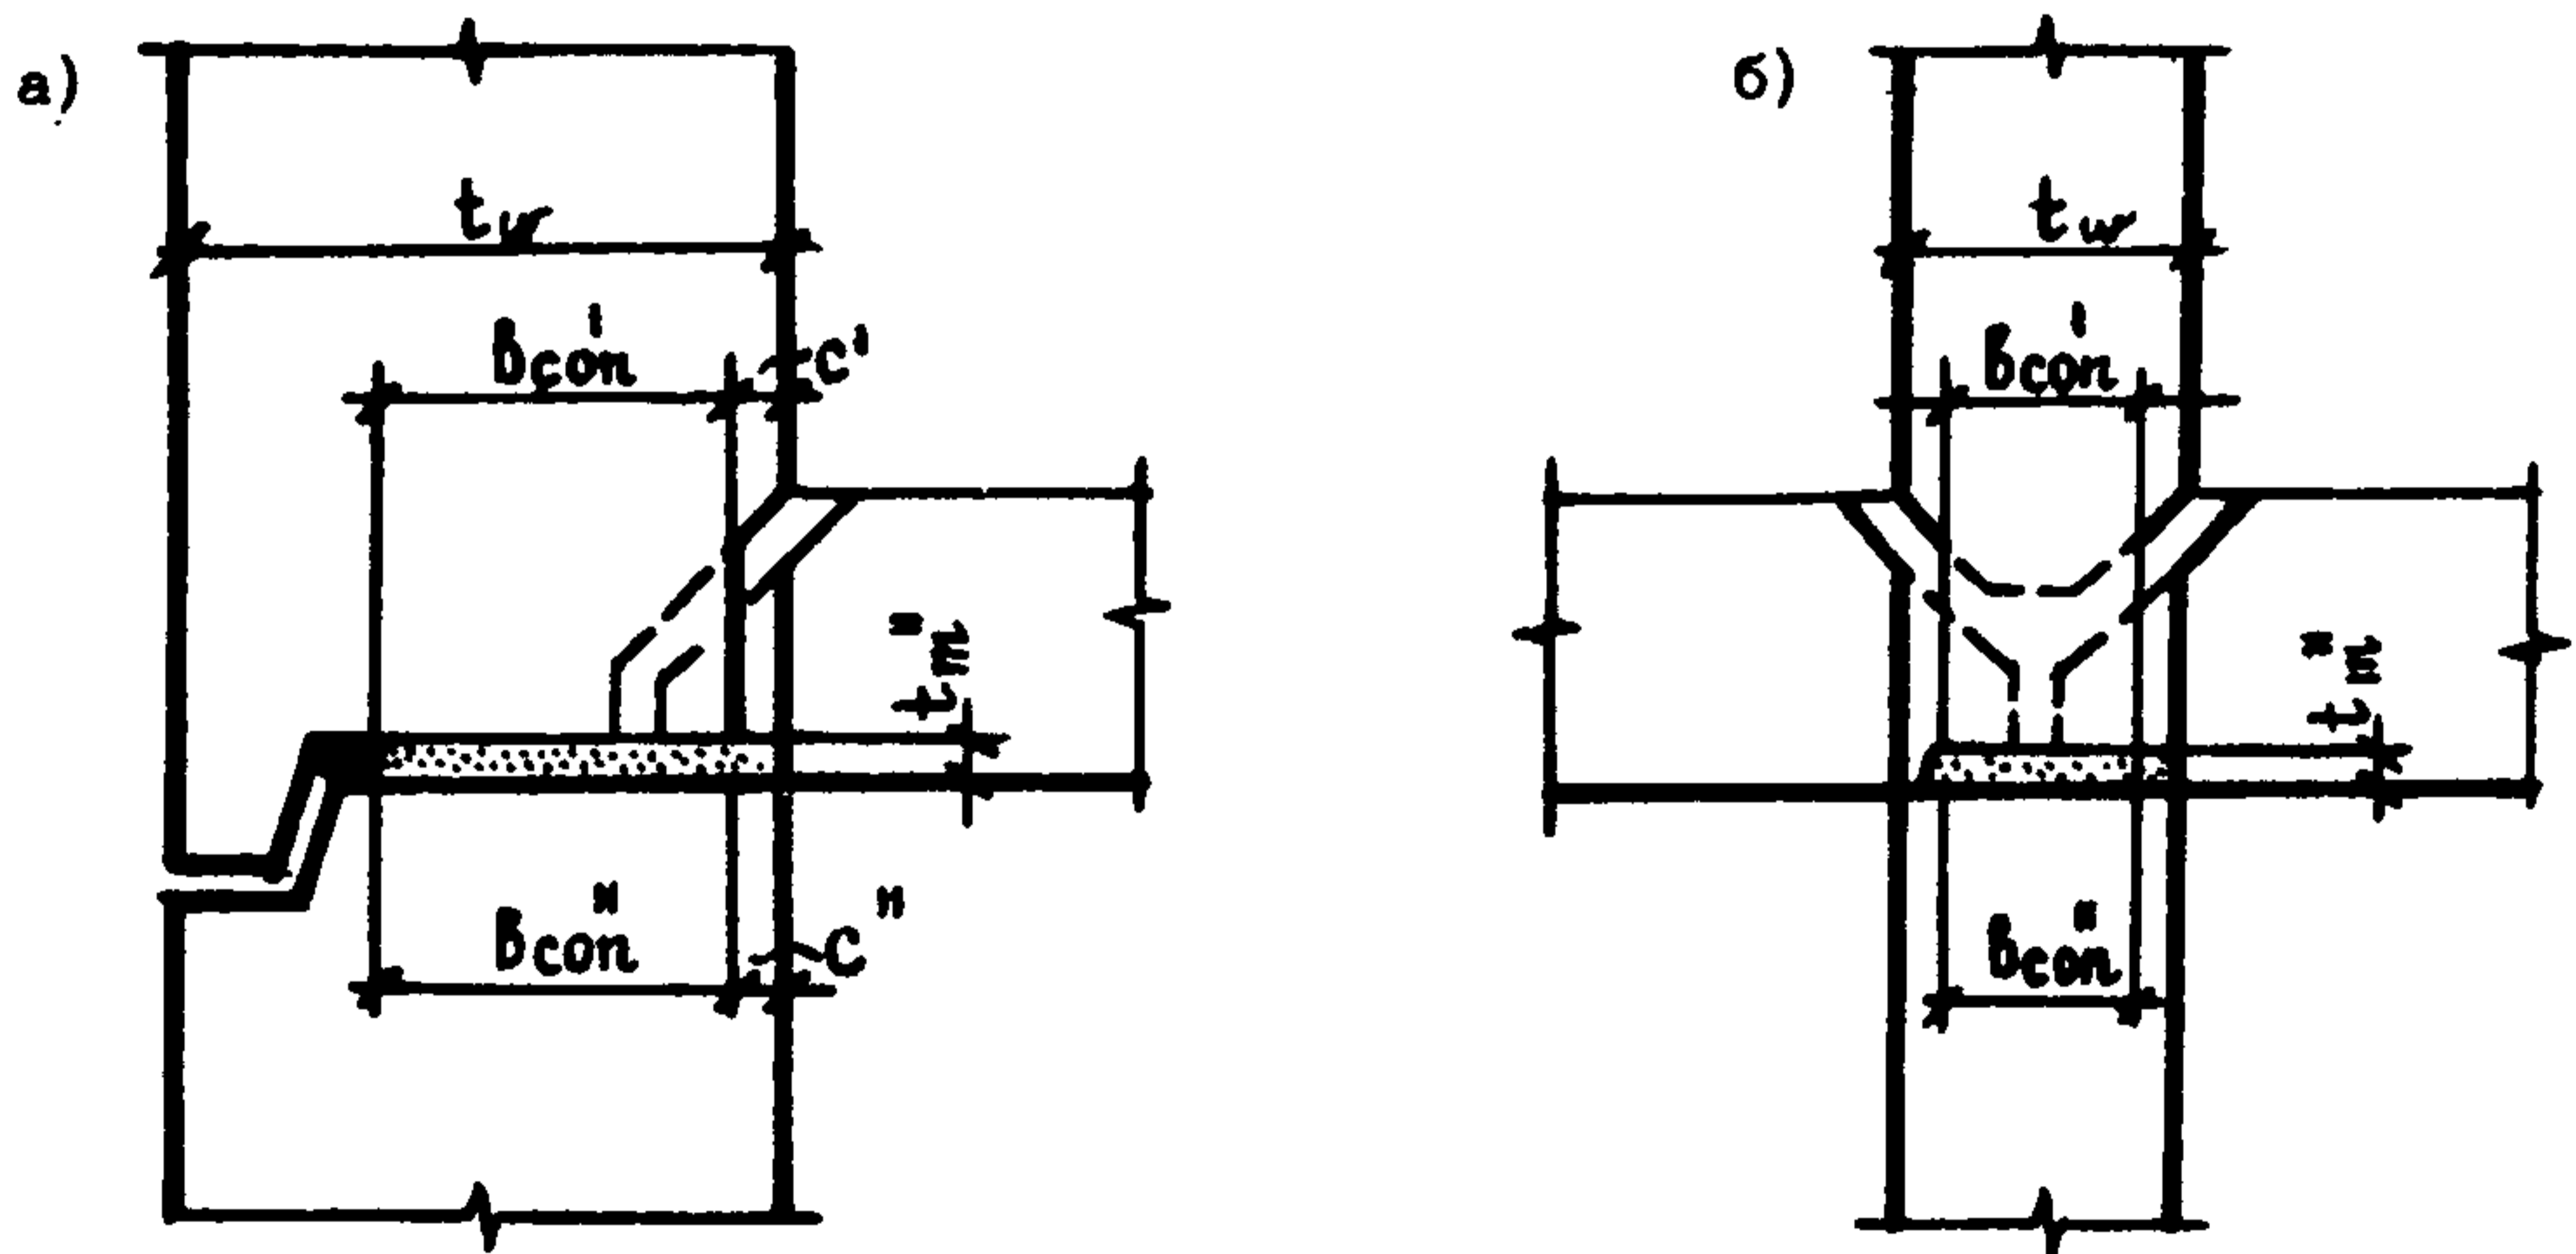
Контактные стыки с односторонним (а) и двусторонним (б) опиранием плит перекрытий
